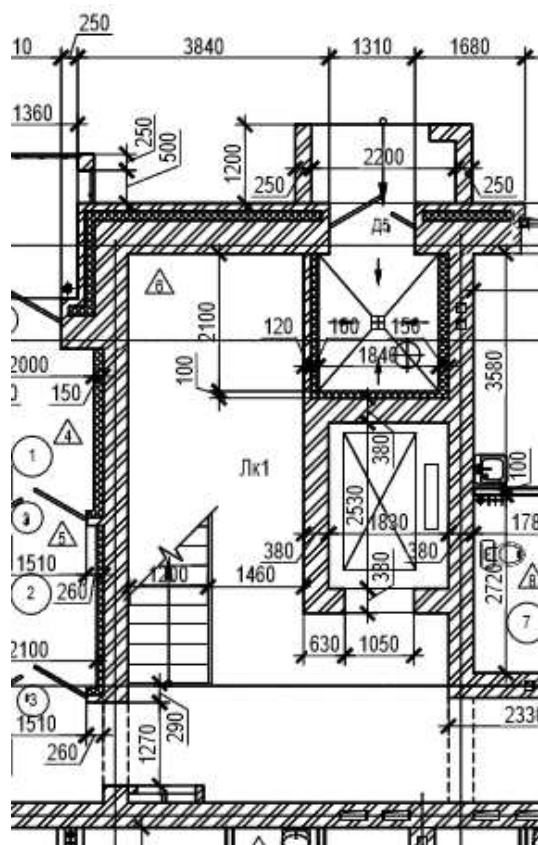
Рассматриваемая плита перекрытия типового этажа
